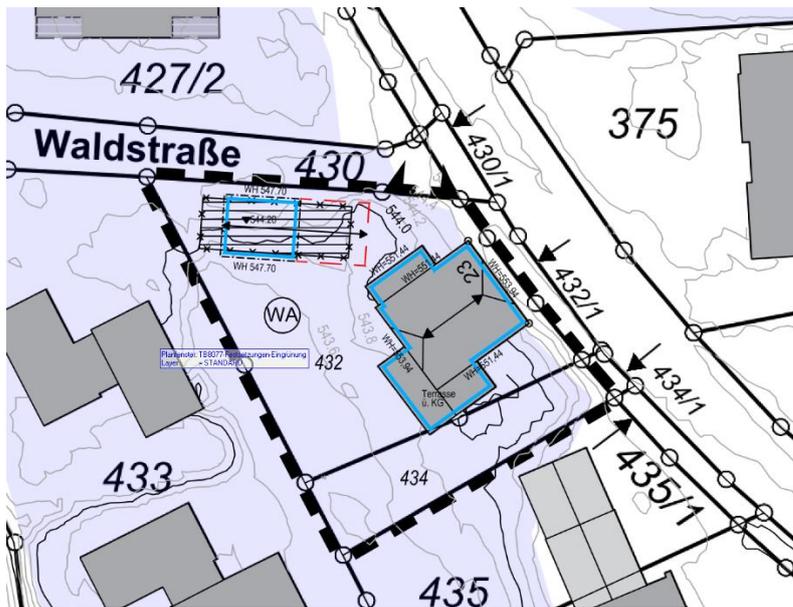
Änderungsbereich Geländedarstellung in Höhenlinien
